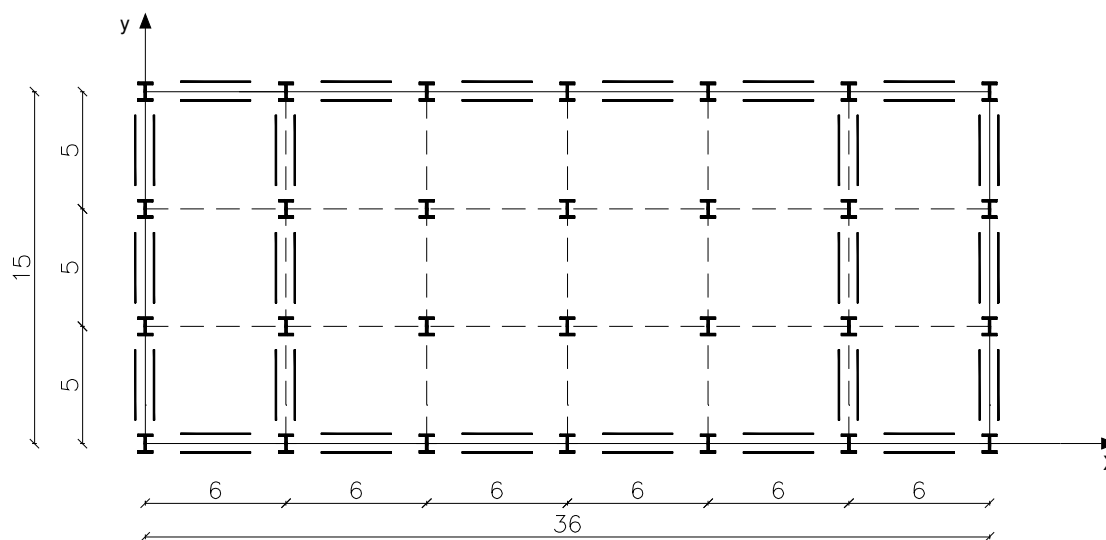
Pianta dell'edificio con in evidenza la disposizione dei *dispositivi isteretici a forma di stella
